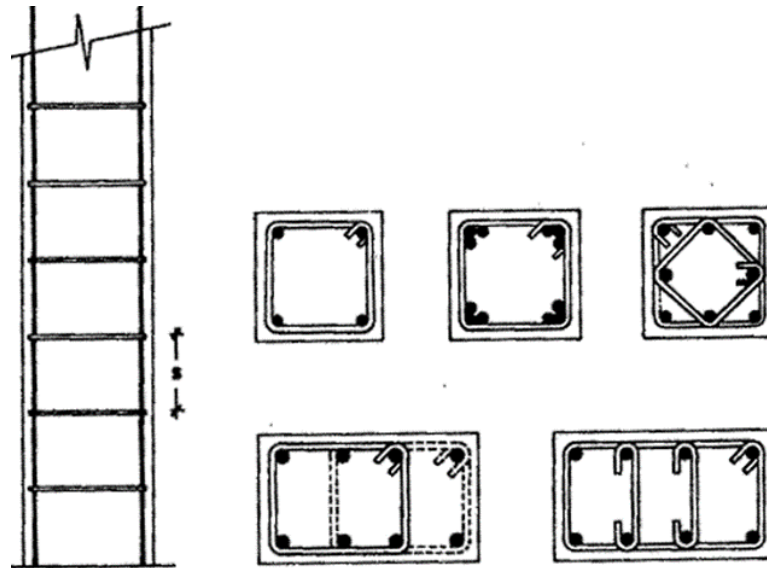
Secciones típicas de soportes de hormigón armado (fuente: Jiménez Montoya, 2009)
